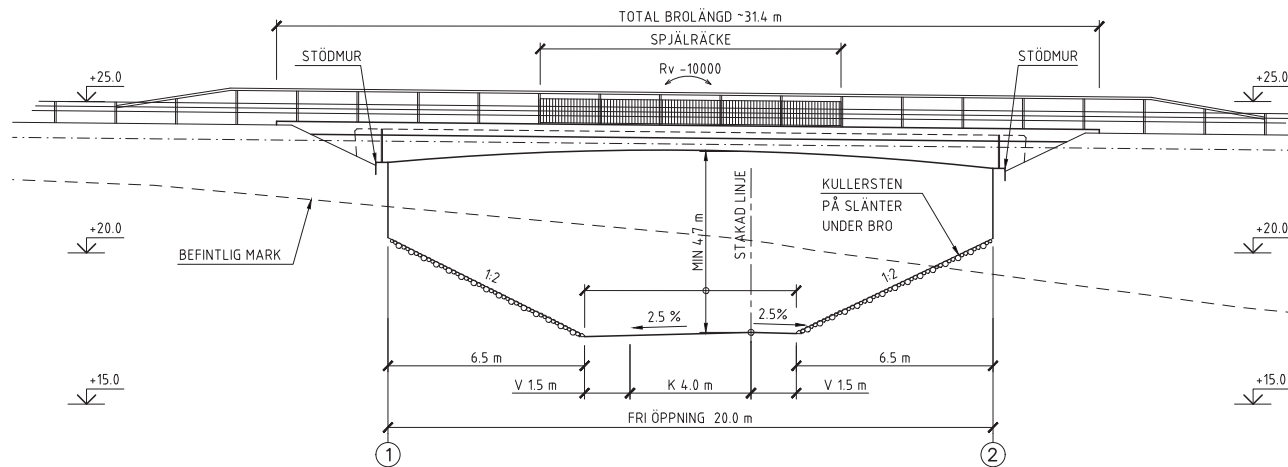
Illustrationsskiss över den planskilda korsningen mellan väg E14 och väg 86/Timmervägen.
